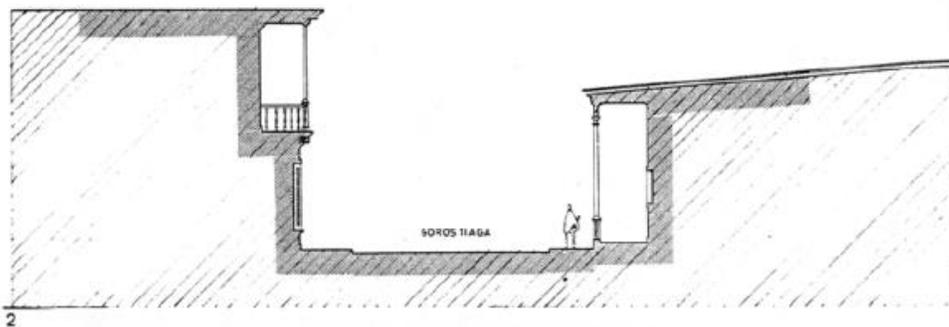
Perfil Calle Zegers Entre Obispo Labbé y Eleuterio Ramírez
